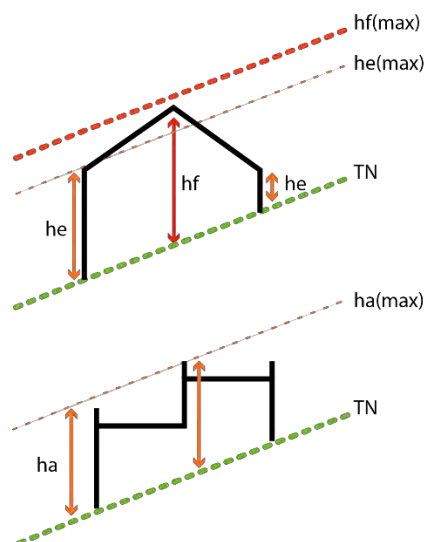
Principe de calcul de la hauteur (avec TN le terrain naturel avant travaux, he la hauteur à l'égout, hf la hauteur au faîtage, ha la hauteur à l'acrotère et hmax la hauteur référence du PLUiH)
